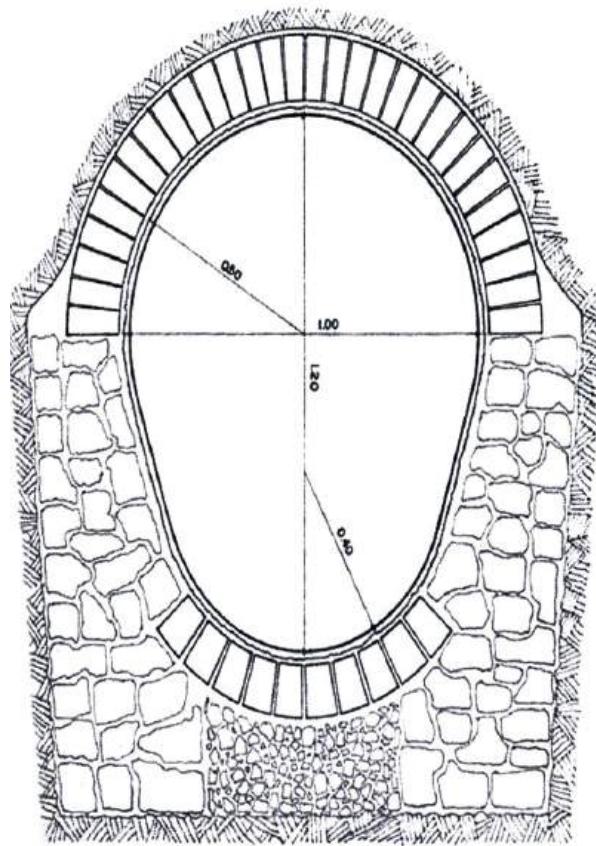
Corte transversal de un caño maestro con piso cóncavo (Memoria).
